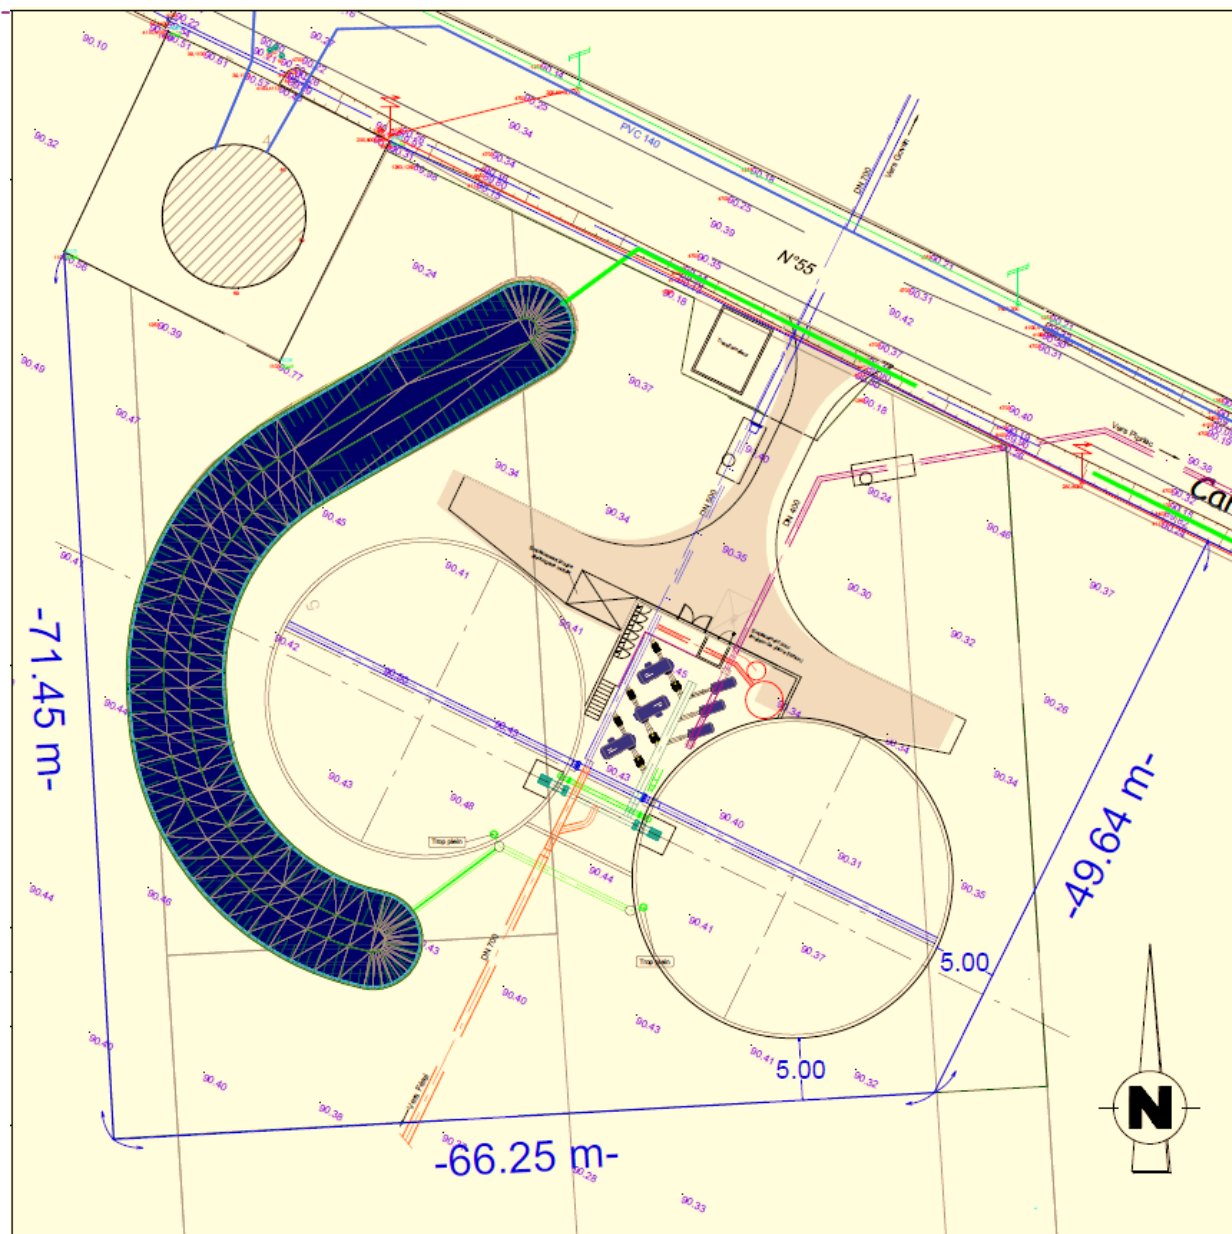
Plan masse du projet de réservoir- SIXT-SUR-AFF
